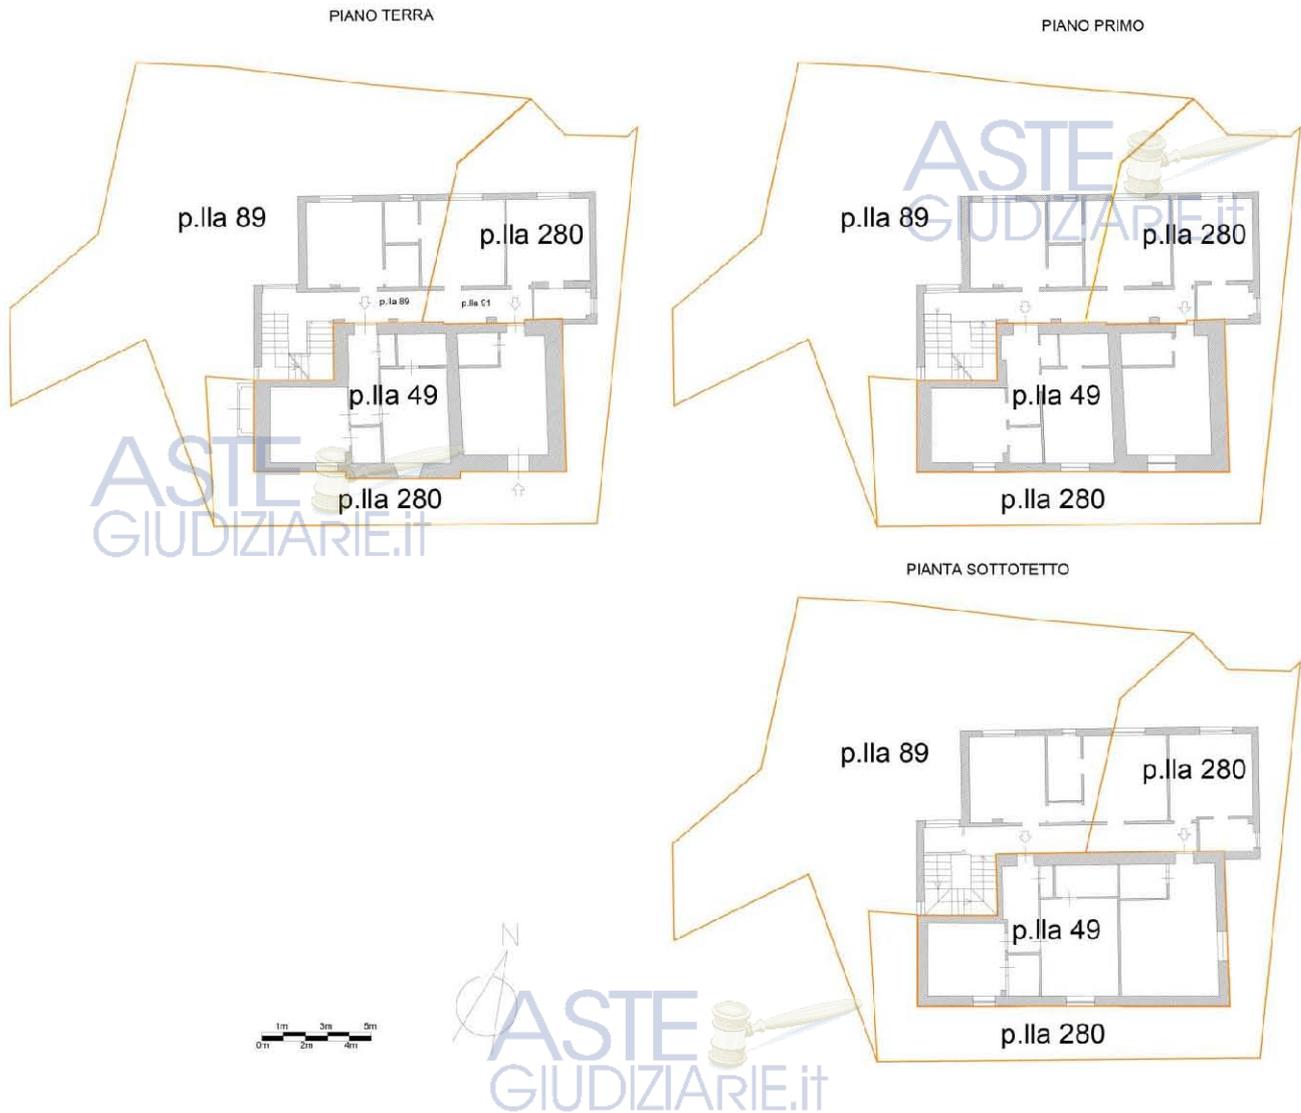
fabbricato da stimare con individuazione della distribuzione sulle singole p.la
